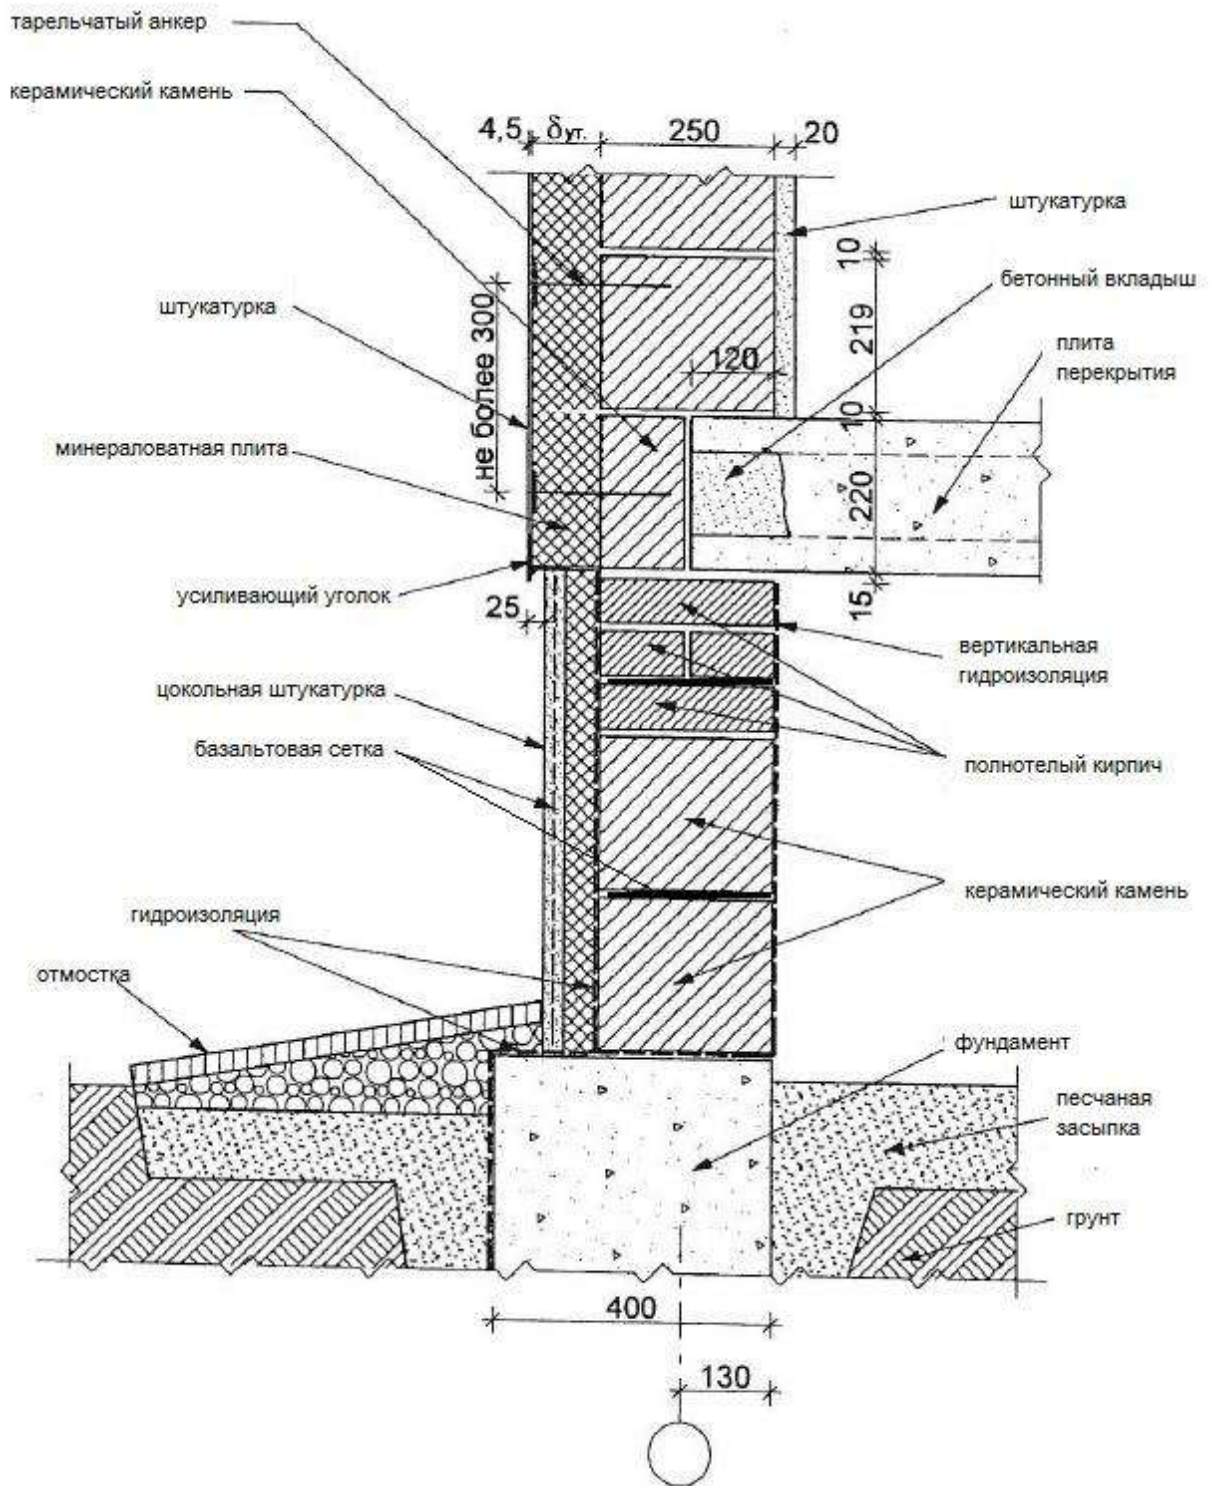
Конструкция двухслойной стены с наружным теплоизоляционным слоем в зоне цоколя
